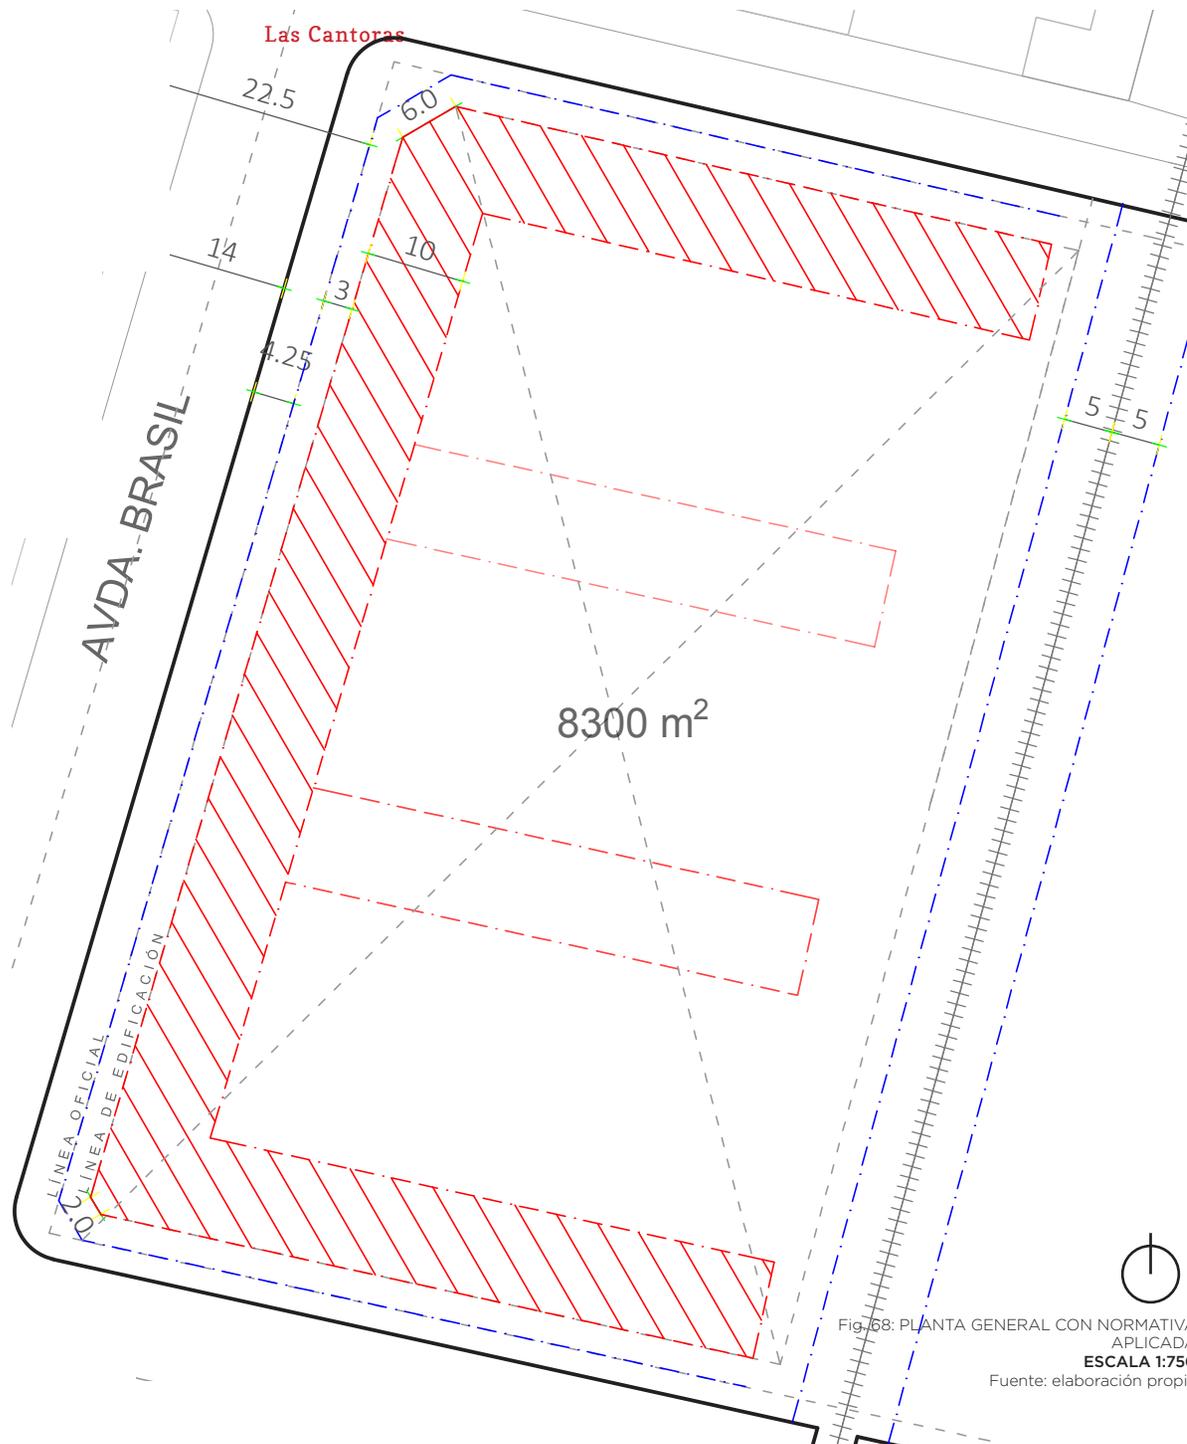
PLANTA GENERAL CON NORMATIVA APLICADA
